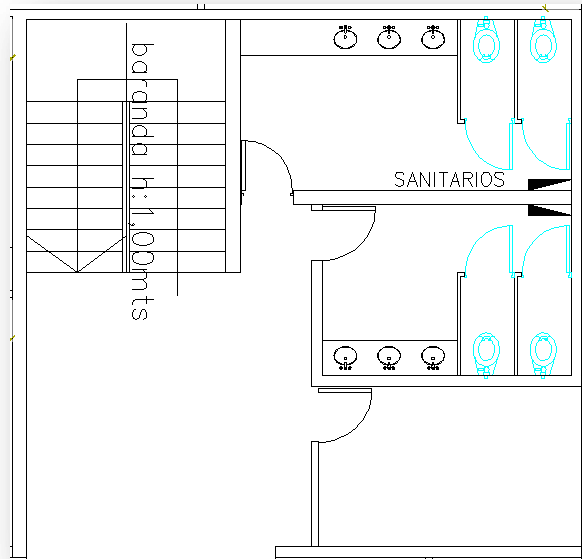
Esquema sanitarios, escalera y box de utilería
